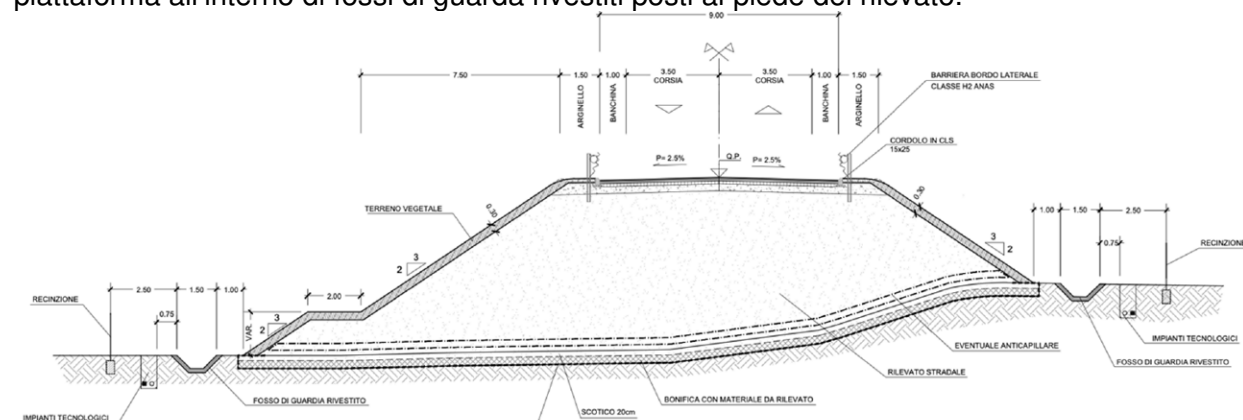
Sezione tipo in rilevato per le strade tipo F1
